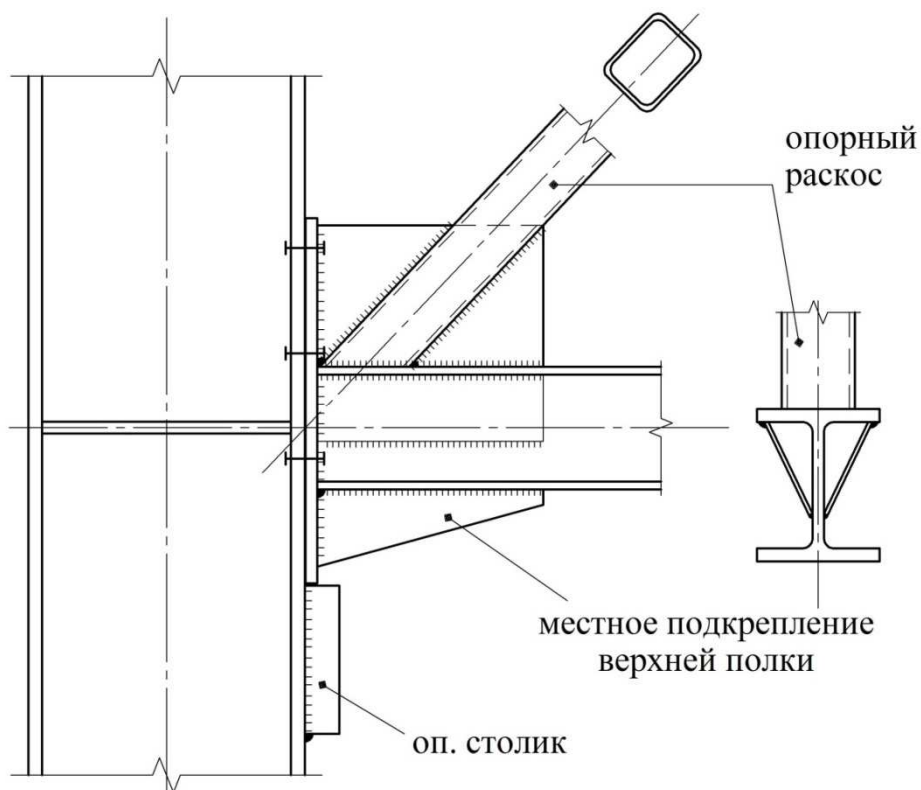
Вариант опорного узла стропильной фермы с нижним поясом из двутавра и опорного раскоса из замкнутого гнутого профиля
